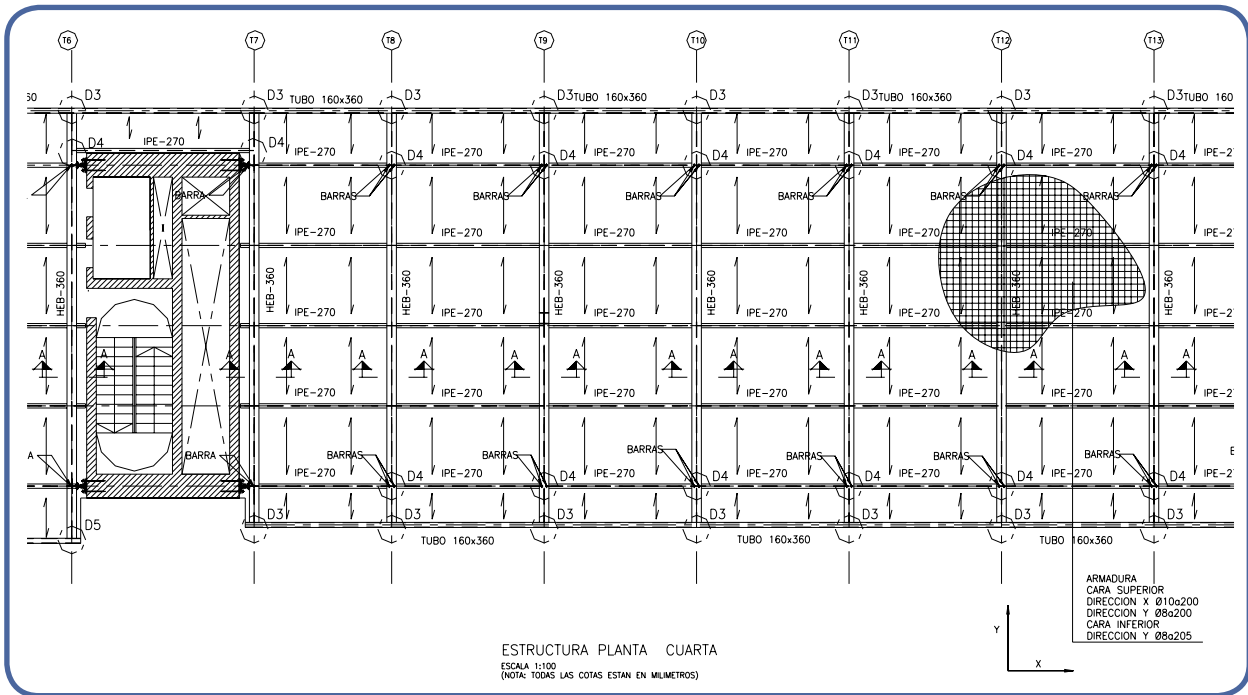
Planta intermedia: emparrillado de vigas longitudinales y transversales con losa de hormigón sobre chapa grecada en la parte superior
